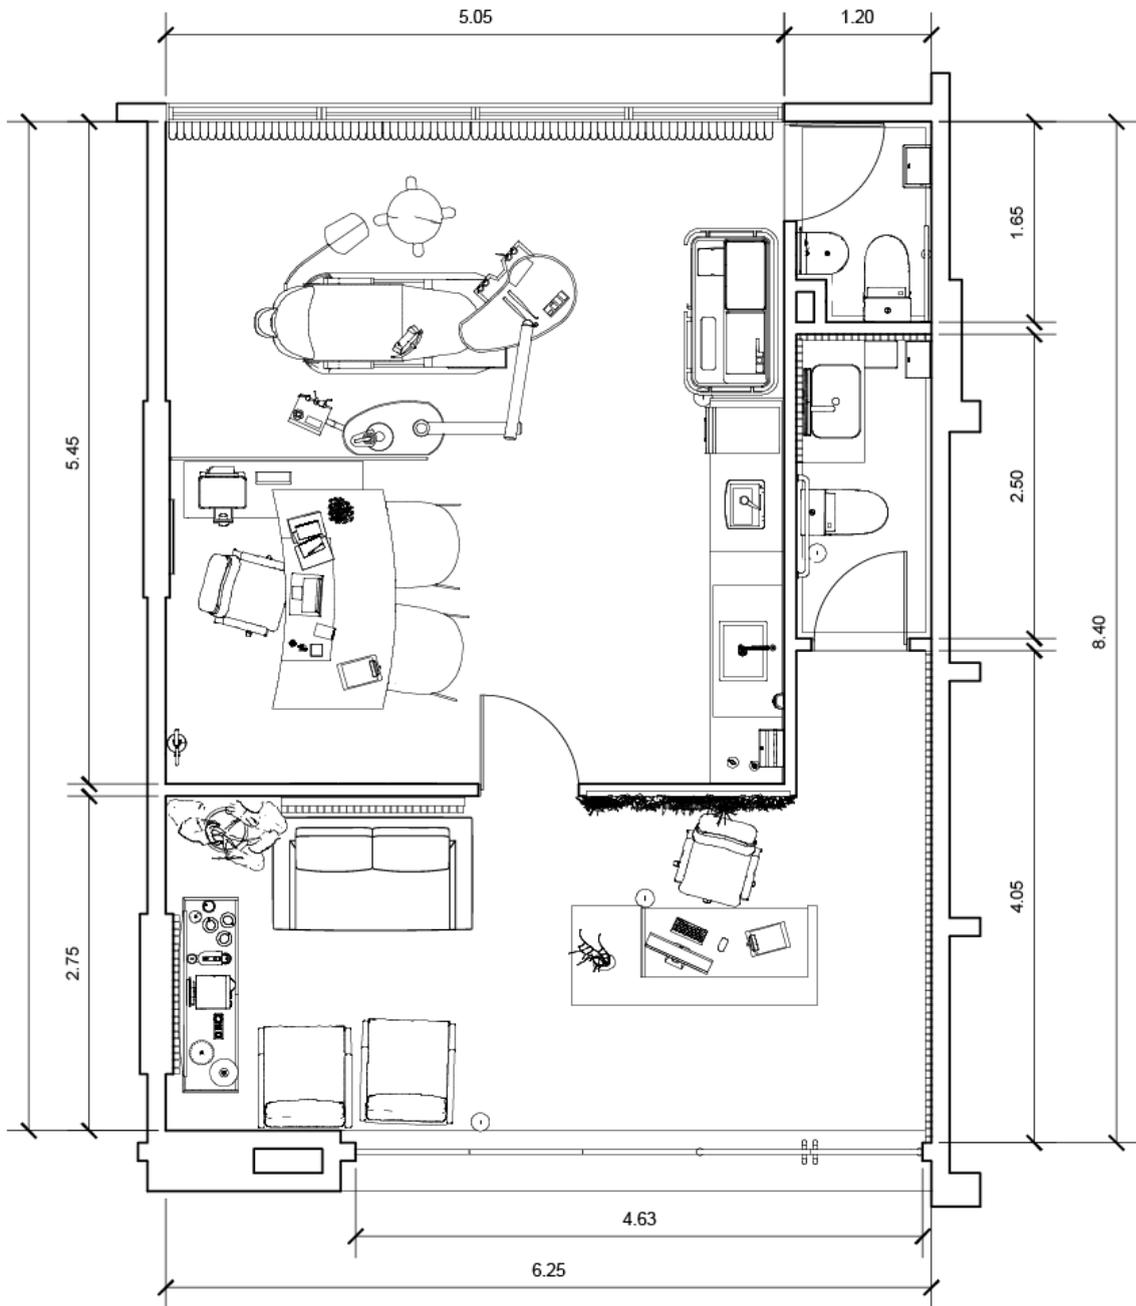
Planta baixa humanizada e setorização do consultório.
